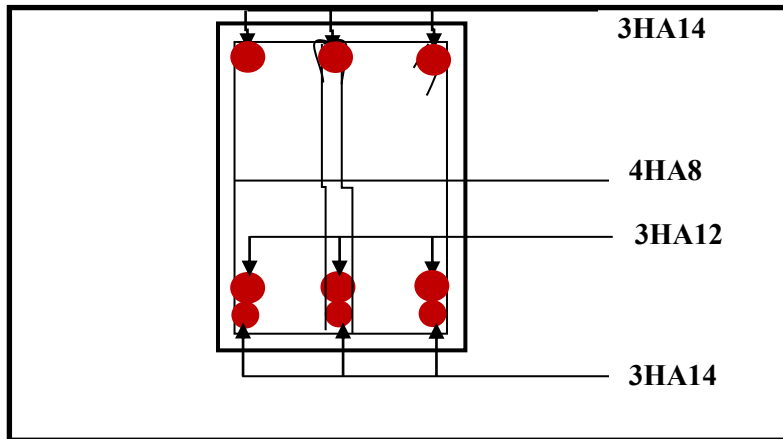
Ferrailage en travée d'une poutre principale.
